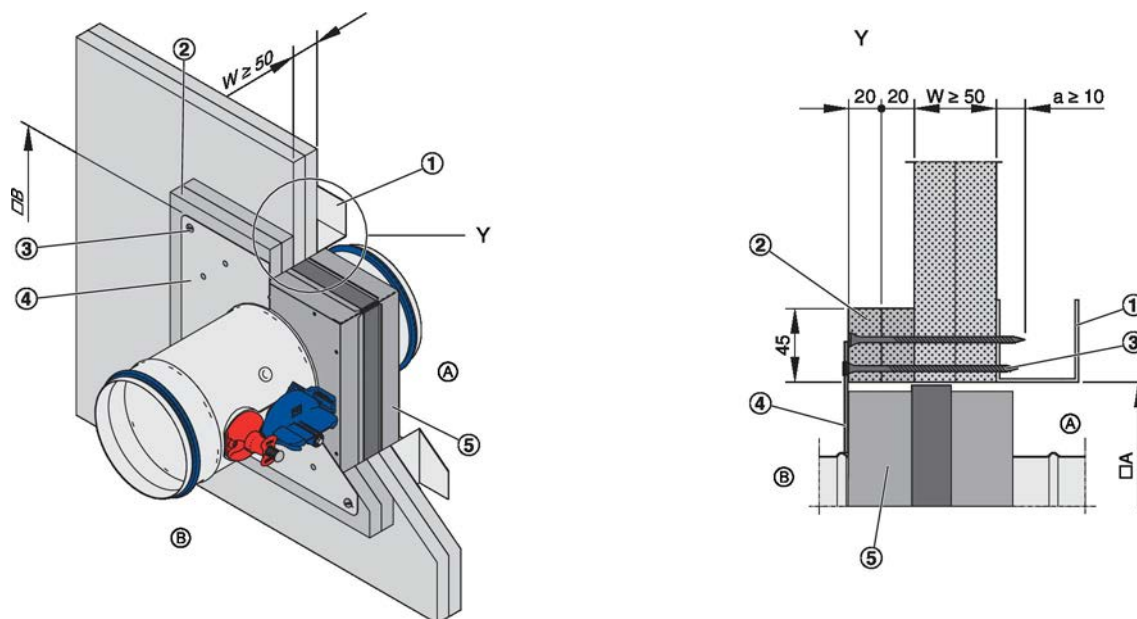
Instalación en seco en patinillos sin estructura de pared metálica
